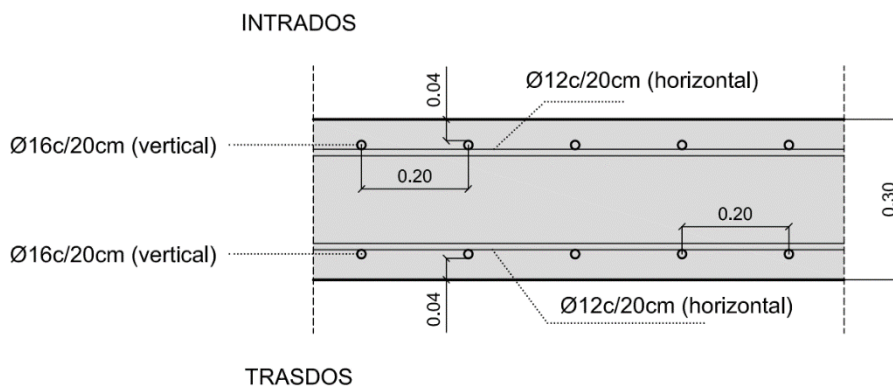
Sección de muro M.09 con armado. Fuente: David Gallardo.
